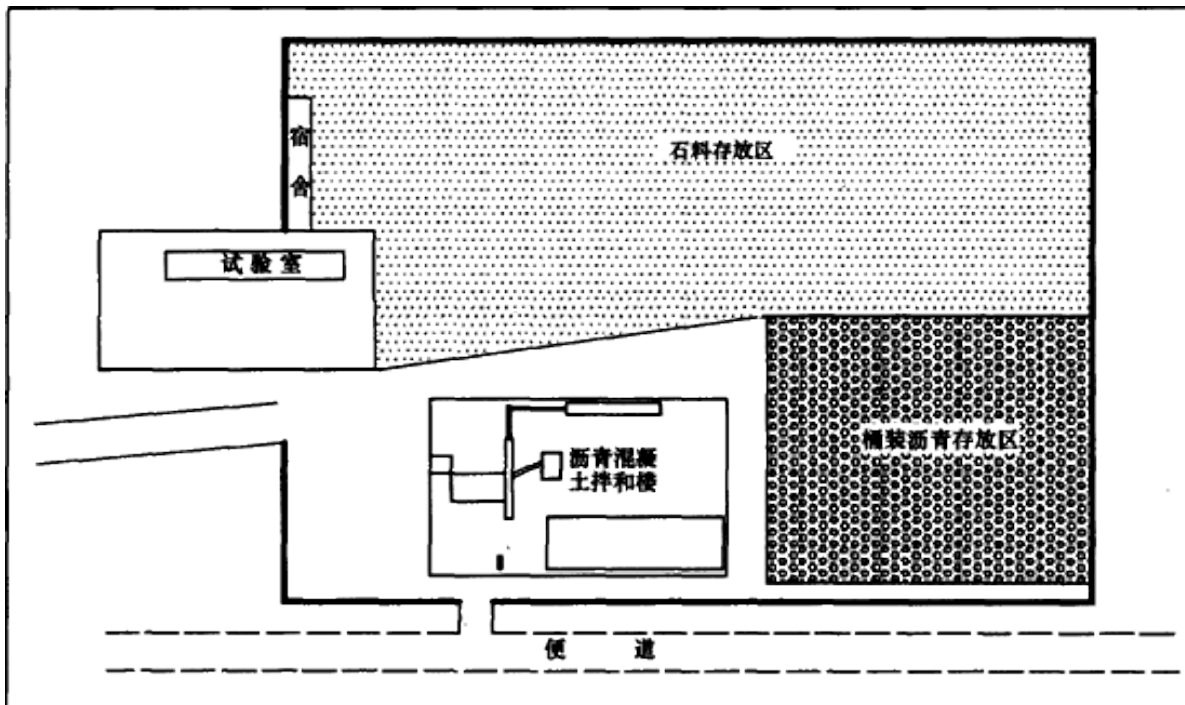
B420163-2 某沥青混凝土拌和站平面布置示意图
